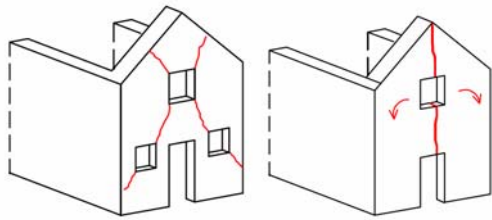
Schadenstyp K3: Versagensmechanismen innerhalb der Fassadenfläche
